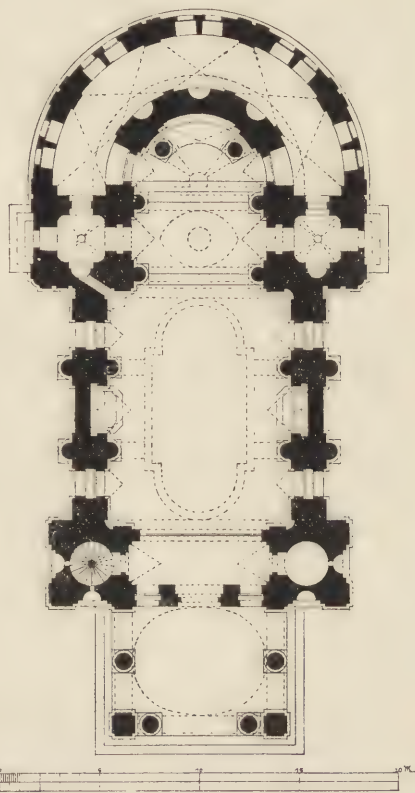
Johanneskirche zu Innsbruck, Grundriss.
